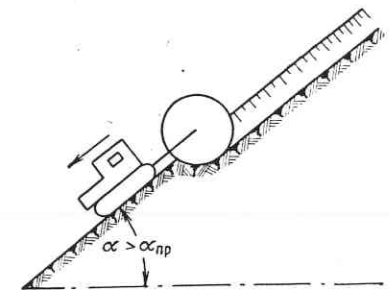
Схема разработки траншеи на продольном уклоне
